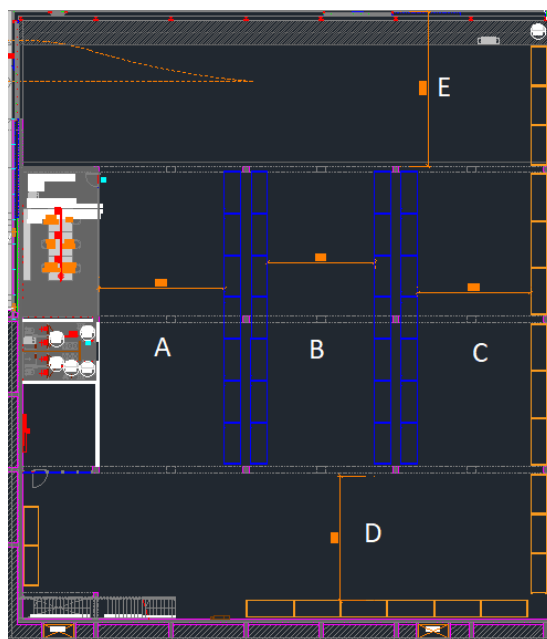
Layout desenvolvido pela Fiber t para as novas instalações (Fonte: Fiber t).
